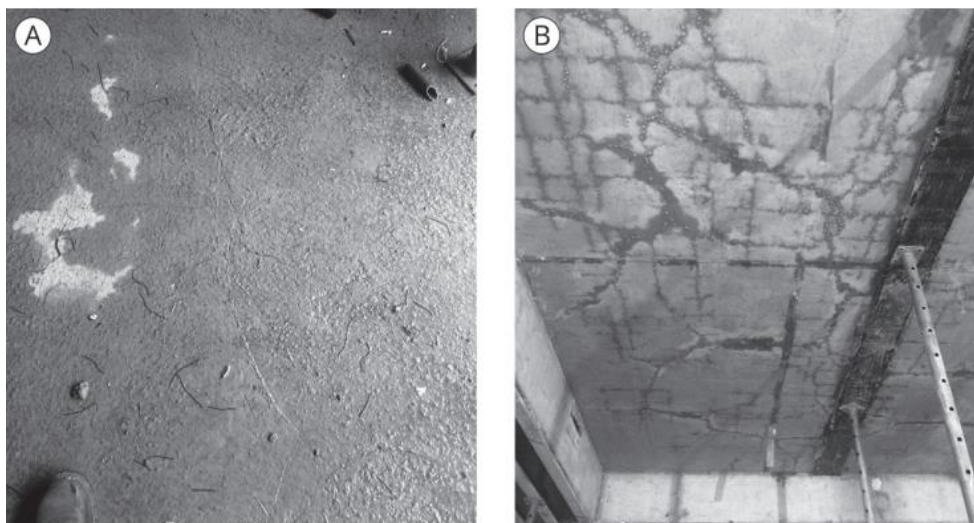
Fissuras de retração em laje com elevado consumo de cimento. (A), microfissuras mapeadas caracterizam bem a intensidade da retração (B), fissuras mapeadas
